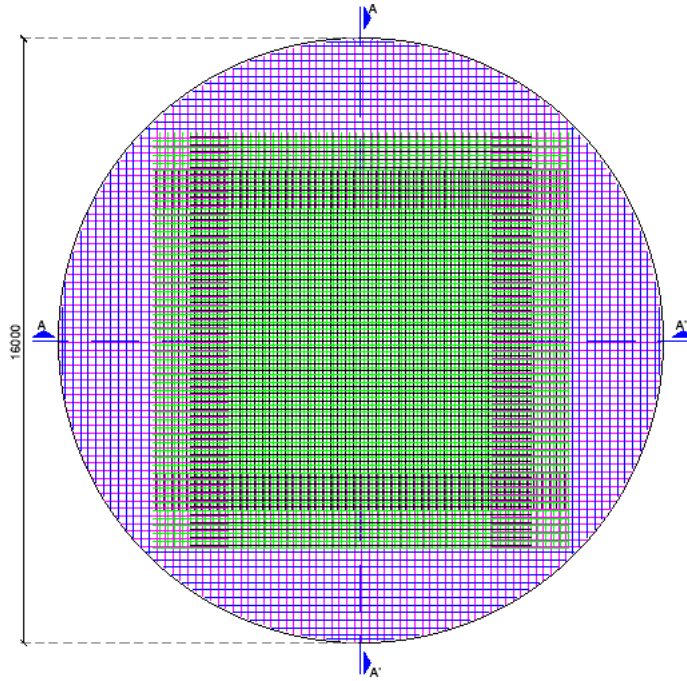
Posicionamiento de varillas longitudinales y verticales inferiores
